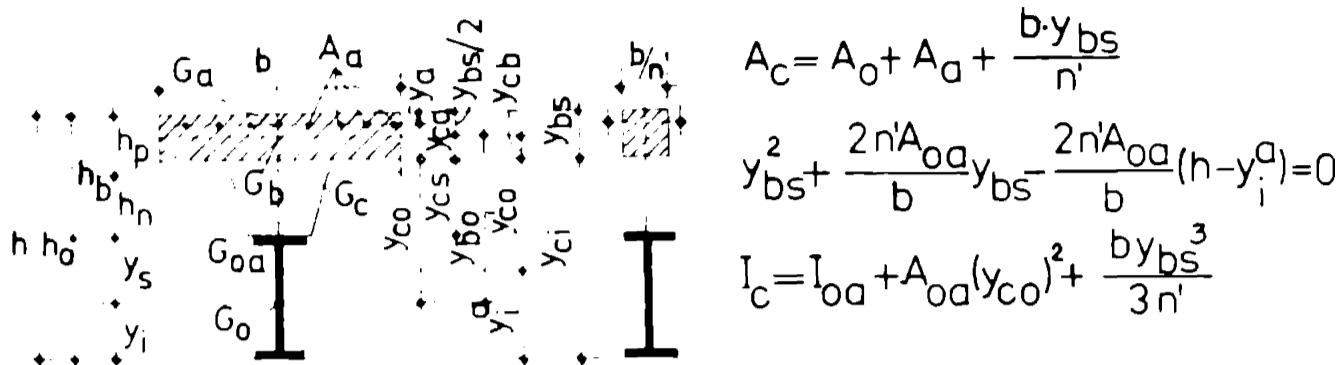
Caracteristici de calcul ale secțiunii compuse pentru axa neutră în dala de beton
